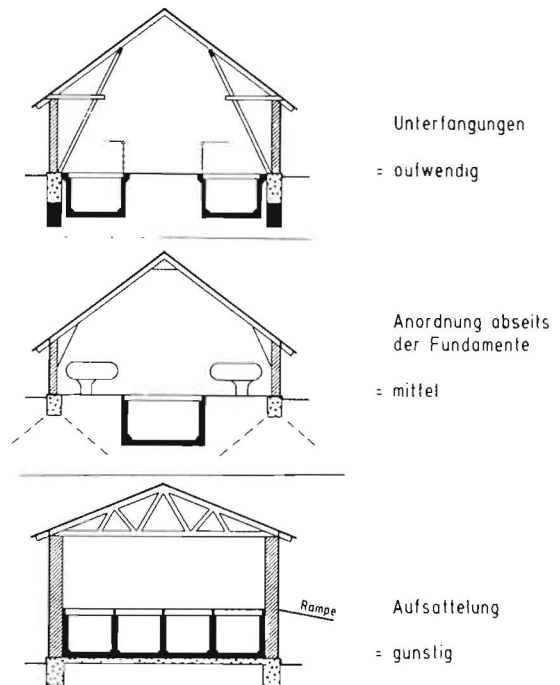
Um- und Ausbau vorhandener Gebäude – Einbau von Güllekanälen
